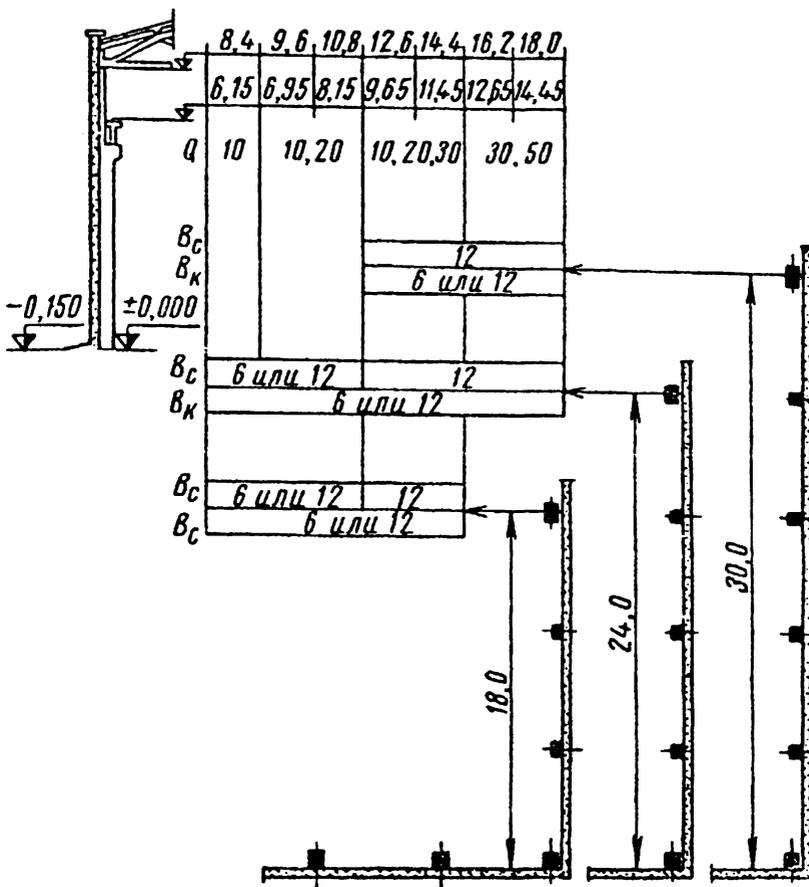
Унифицированная габаритная схема для одноэтажных зданий с мостовым краном:
